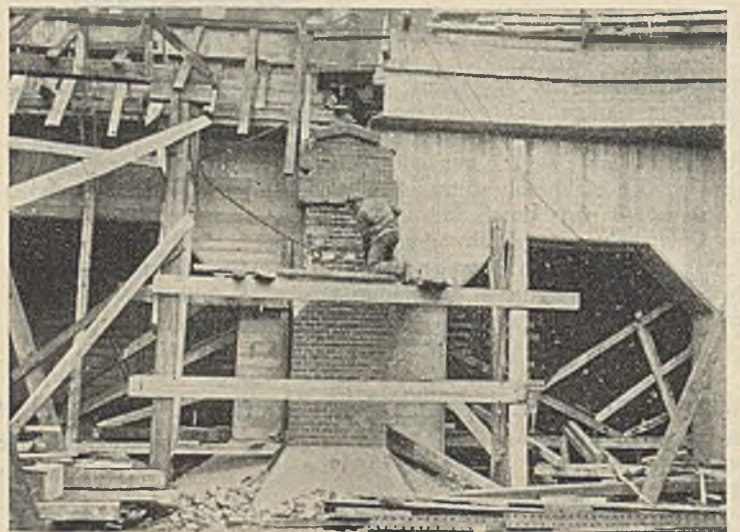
Rechts fertige Decke, links Betonierung einer Decke unter Behelfsbrücke, Pfeilerabstimmung zwecks Ummantelung der Vorsprünge.
